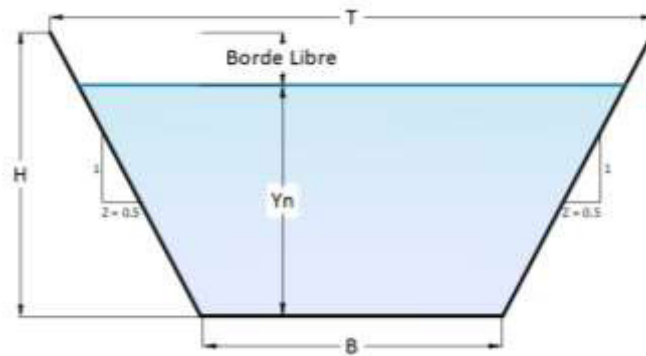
Esquema de sección transversal de canales trapezoidales
